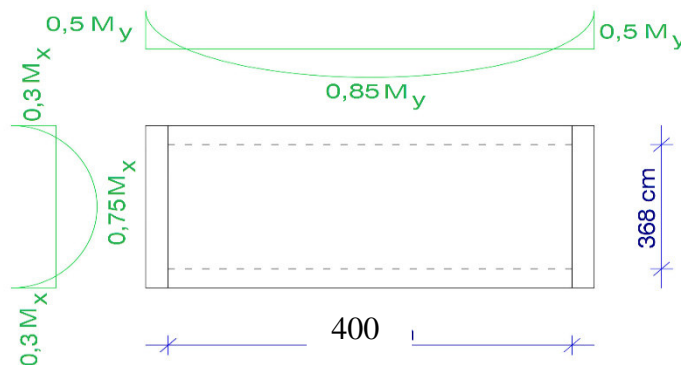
Schéma du panneau de la dalle appuyée sur 4 coté.
